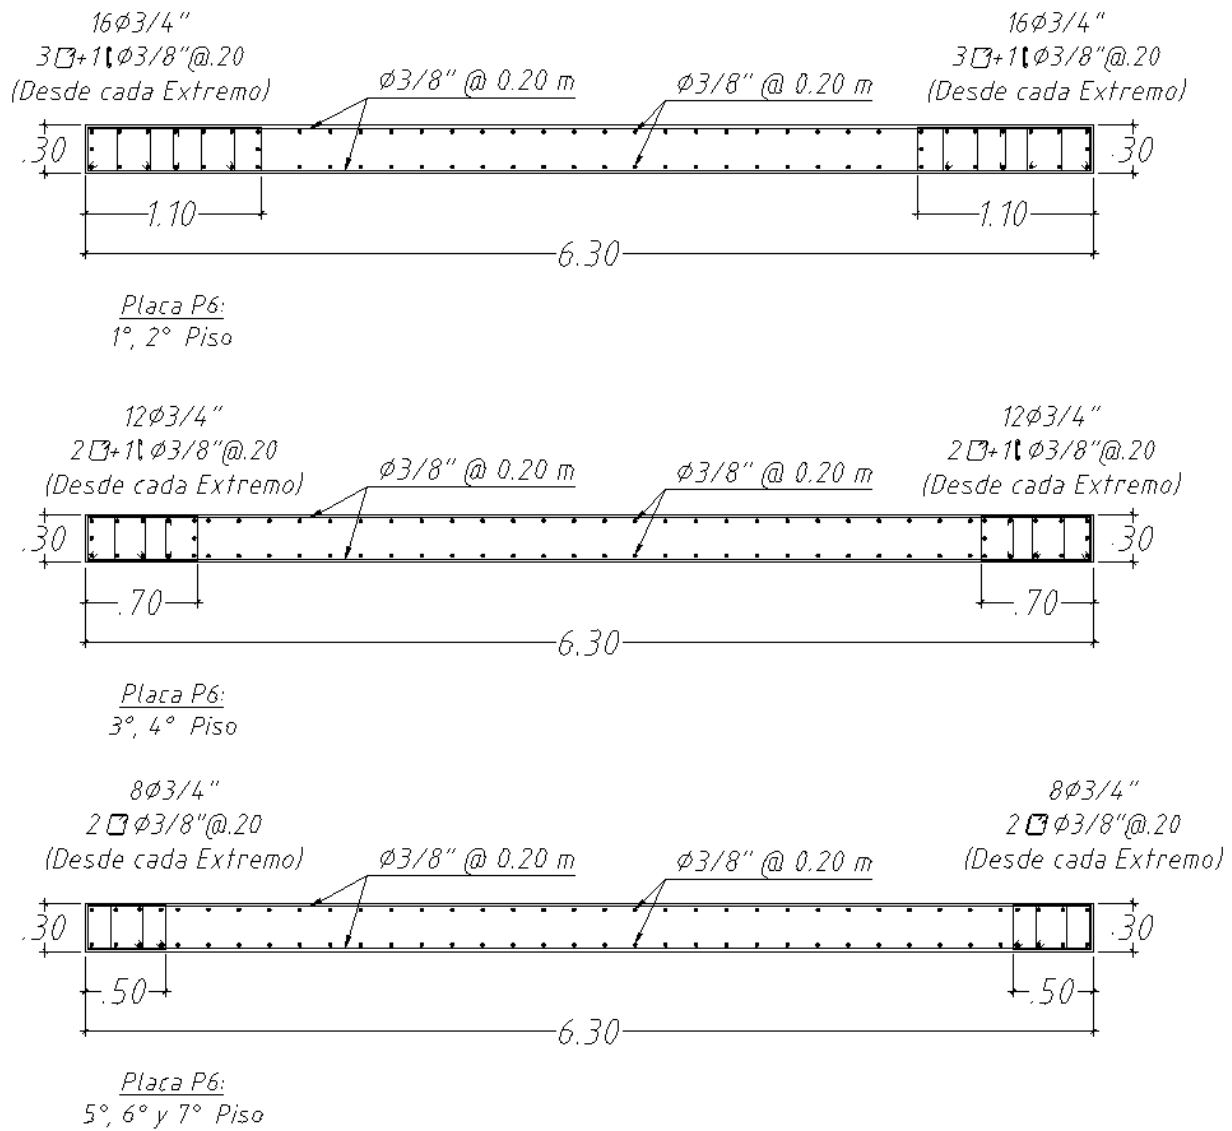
Distribución del refuerzo longitudinal y transversal en la placa PL-06.
